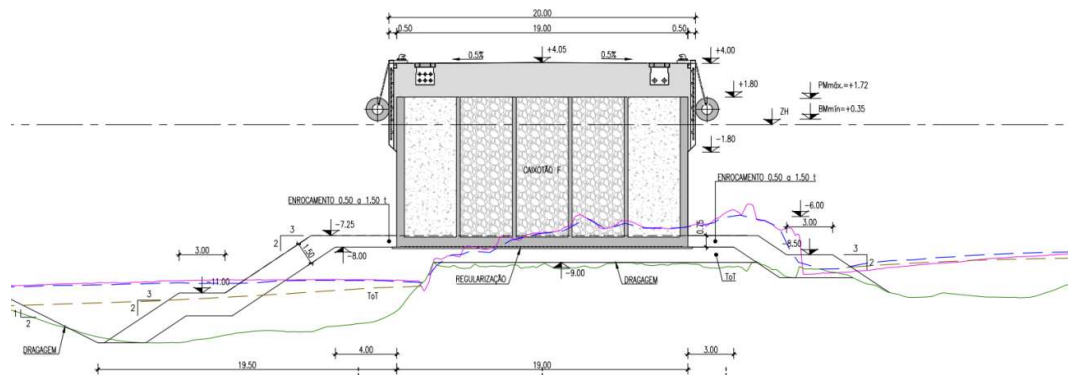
Corte transversal da Ponte-Cais, na zona de caixotão.
